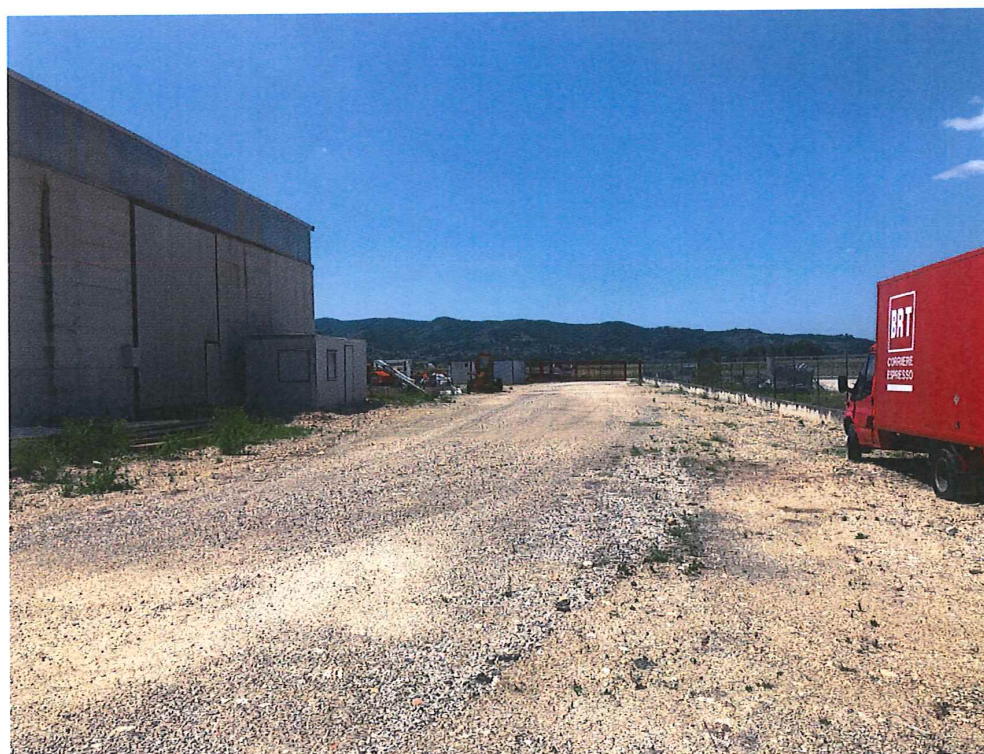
Bettona. Piazzale esterno lato nord-ovest. Sullo sfondo l'ingresso carrabile.
